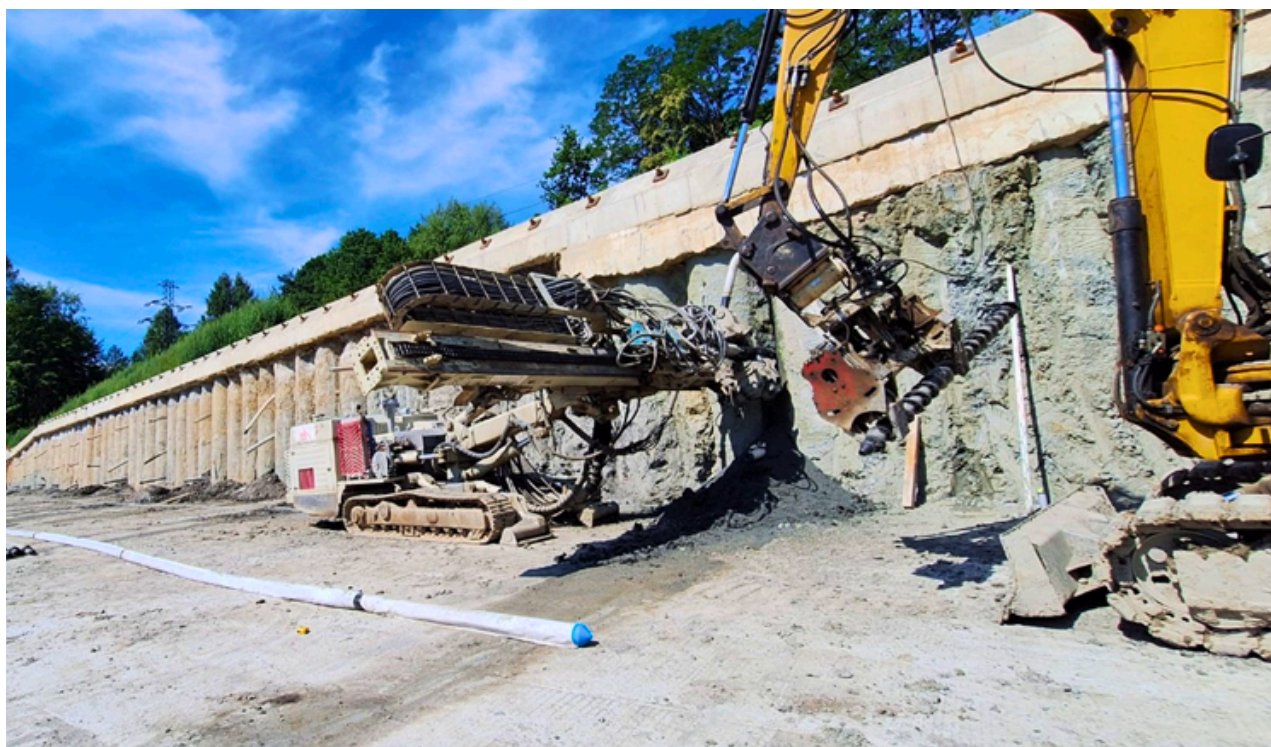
Kotwiona konstrukcja oporowa w fazie największego odstąpienia (konstrukcja KO_K4)
